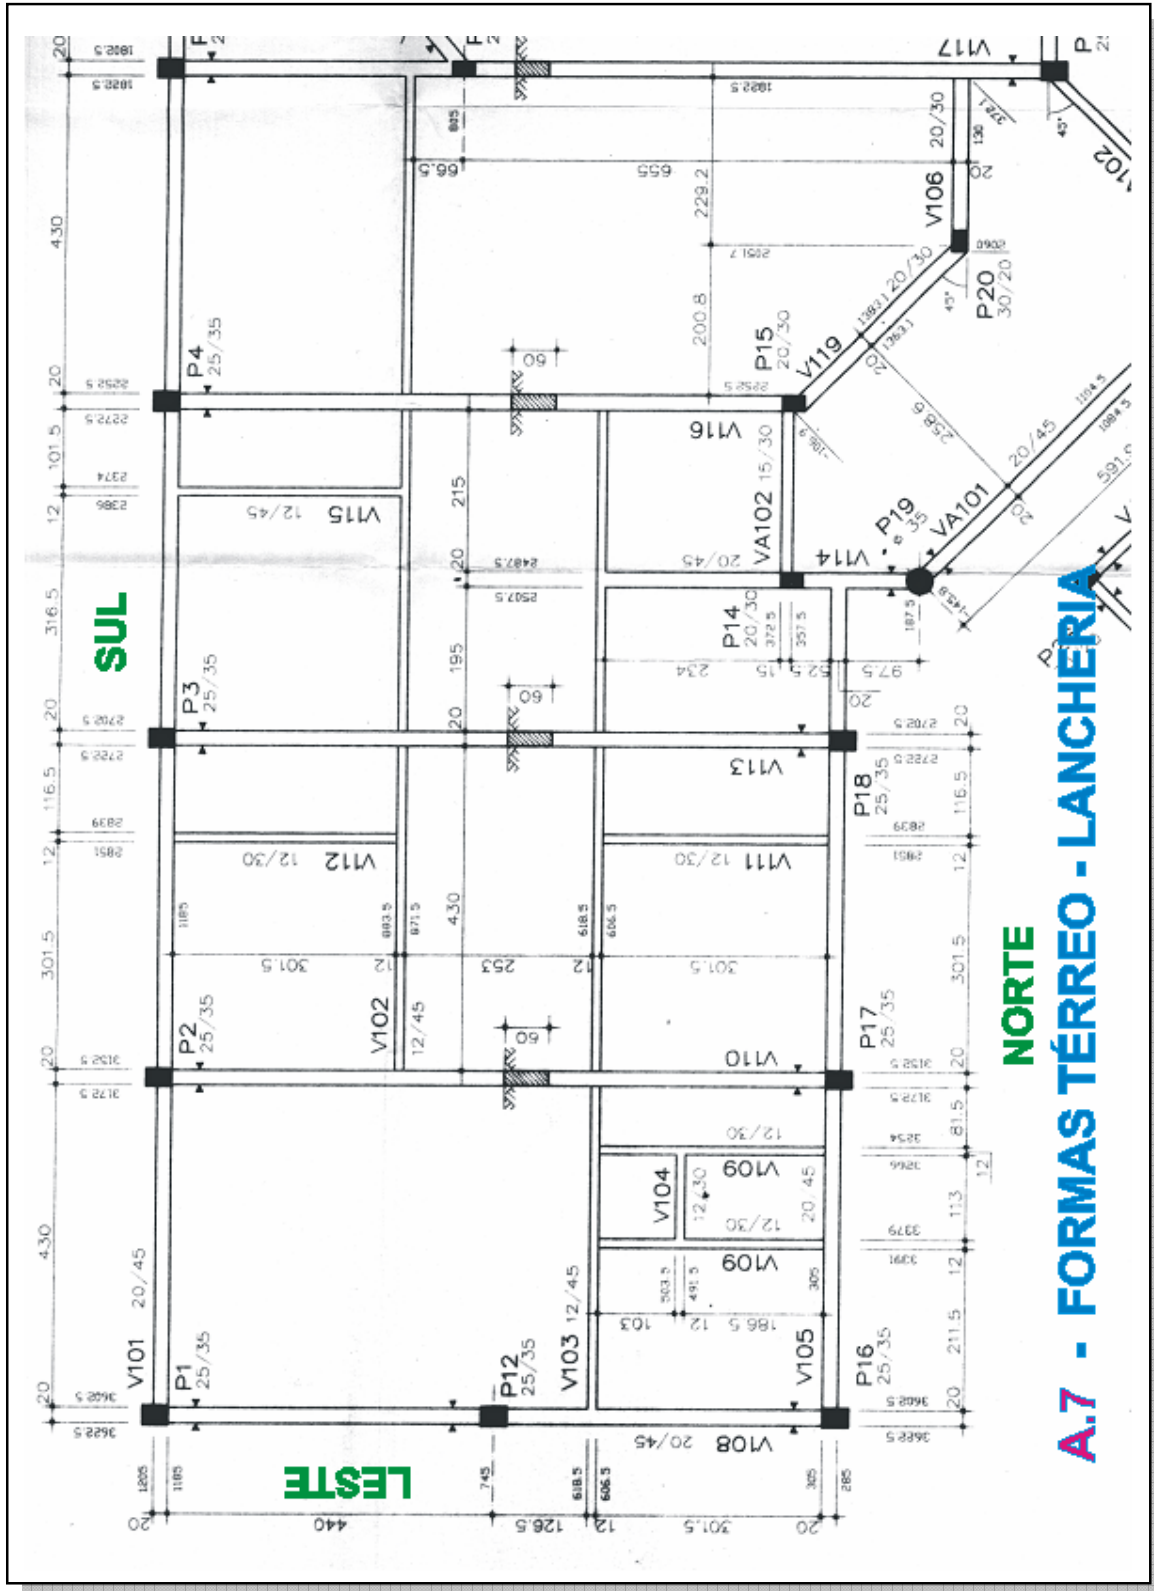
Planta de formas pavimento térreo setor Lancheria (ISAIA, 2001, p. 38)
